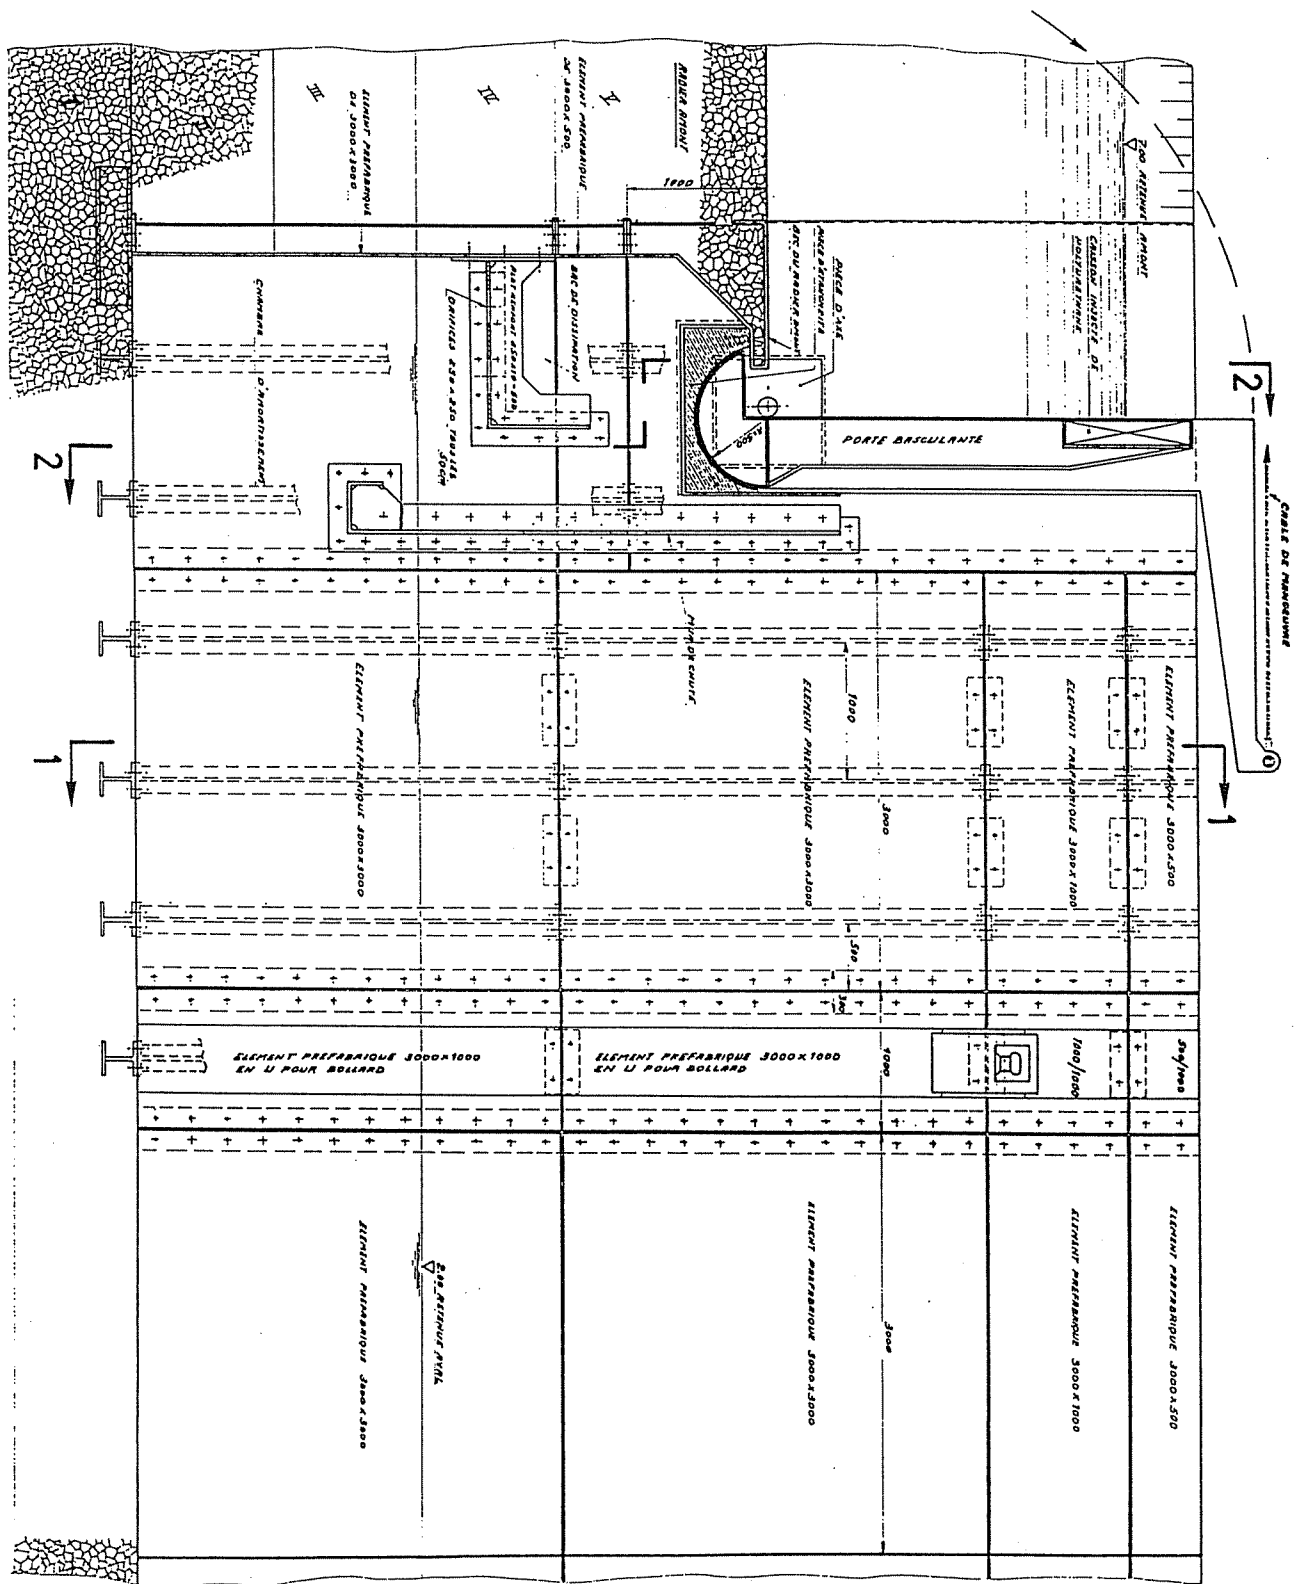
Plans et coupes dans la tête et la porte amont.
